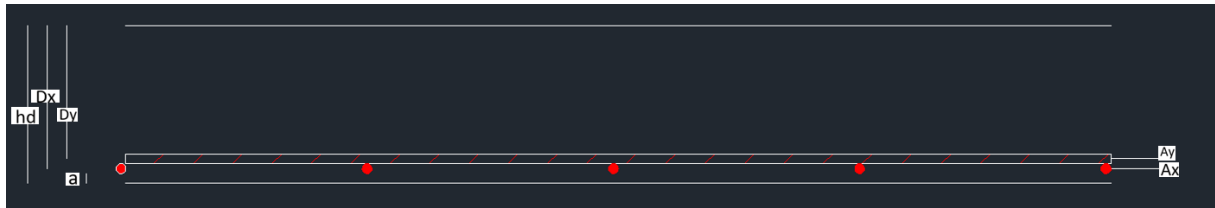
Schéma représentatif de la coupe transversale de la dalle pleine
